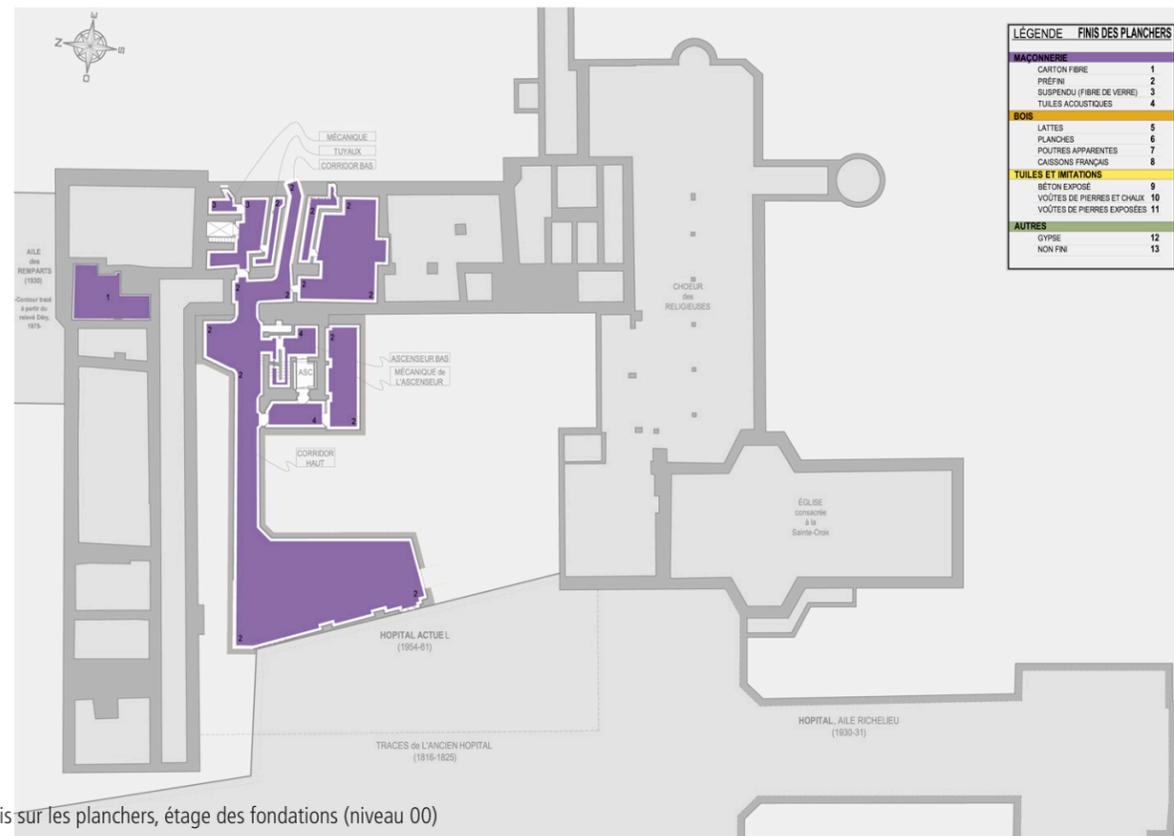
Plan des fins sur les planchers, étage des fondations (niveau 00)
